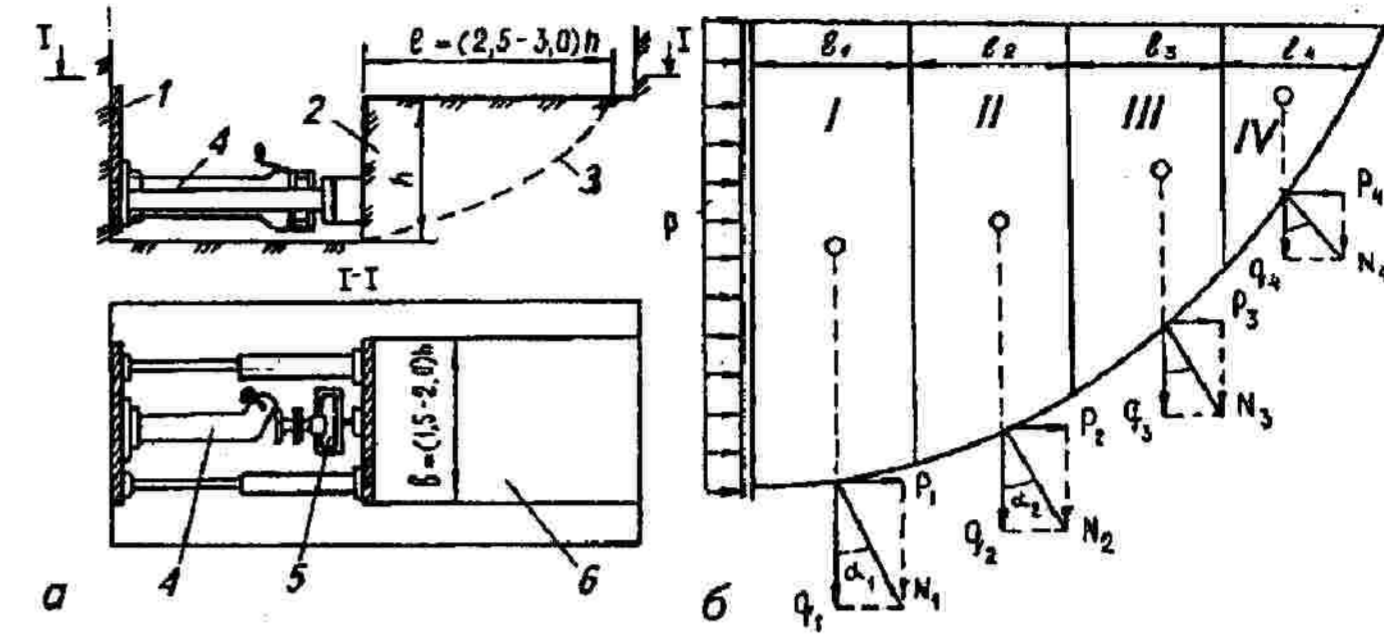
Испытания грунта на сдвиг выпиранием:
